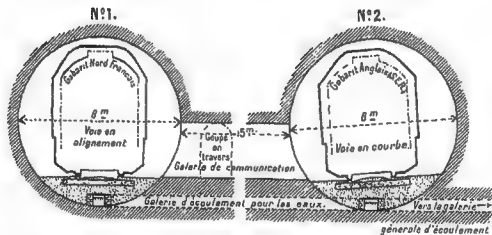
Coupes transversales d'une galerie du tunnel.
